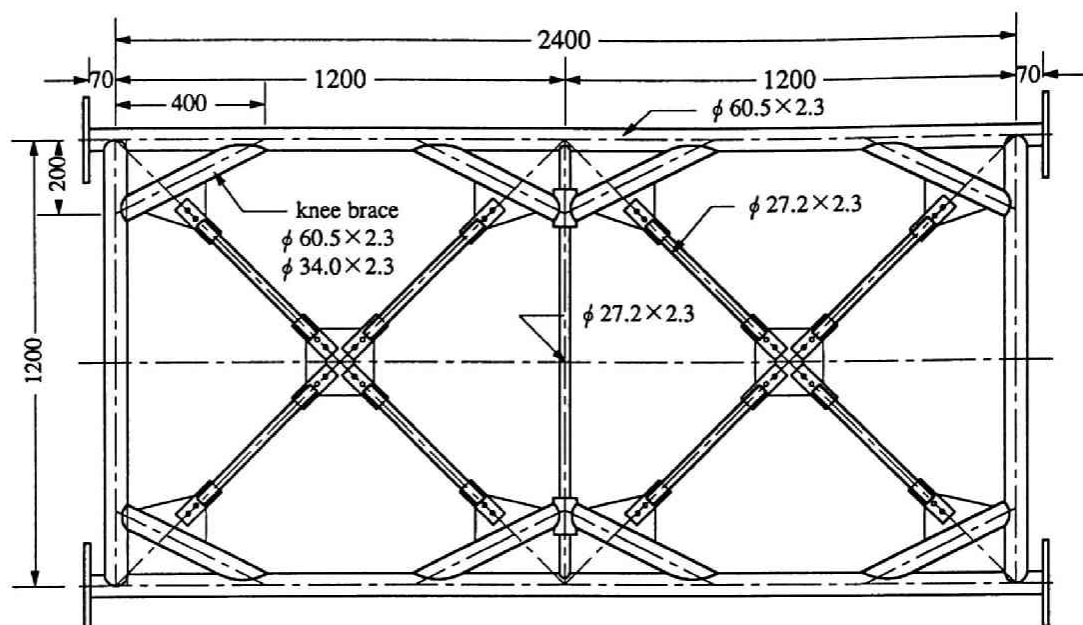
Knee Brace 形式（タイプ D）試験体（単位：mm）
